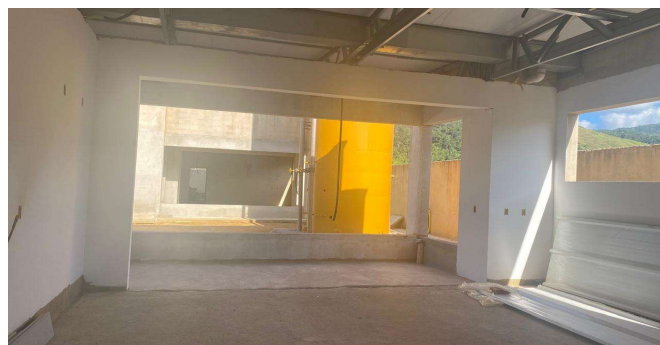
APLICAÇÃO MANUAL DE MASSA ACRÍLICA EM PANOS DE FACHADA SEM PRESENÇA DE VÃOS, DE EDIFÍCIOS DE MÚLTIPLOS PAVIMENTOS, DUAS DEMÃOS.
